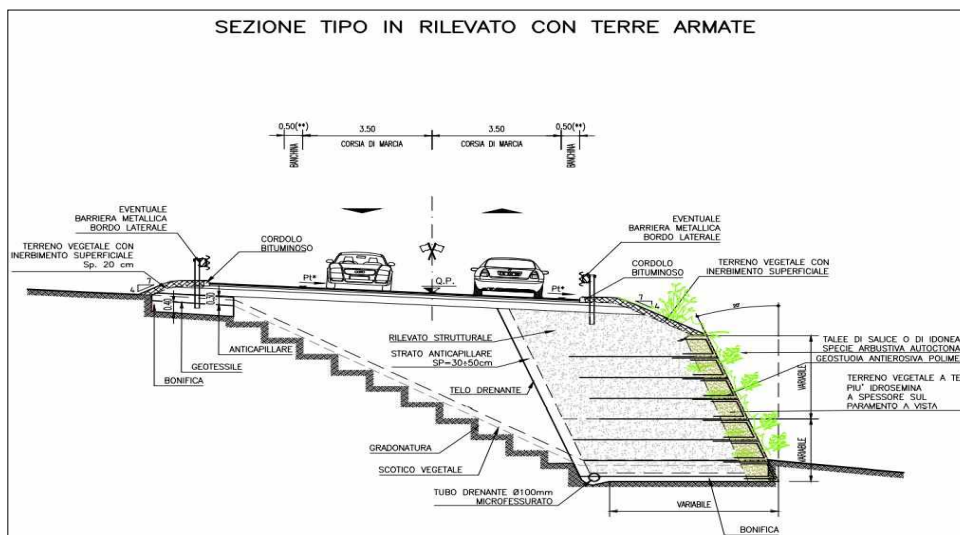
Sezione tipo in rilevato con terre armate rettifica Curve
